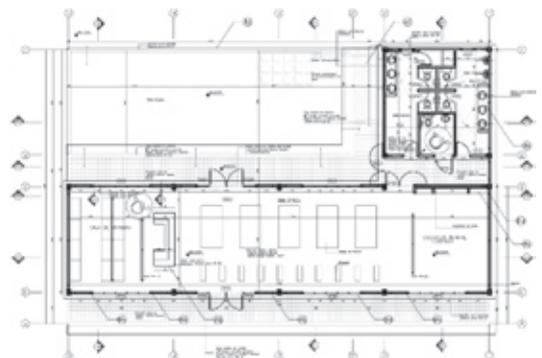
標準型地域図書館の平面図 (メストレ氏提供)
